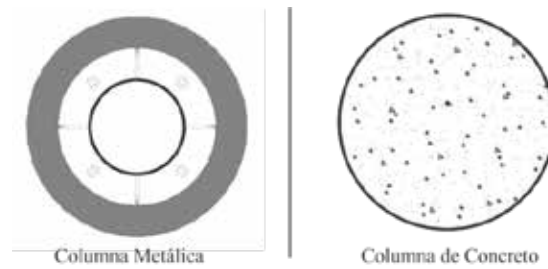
Secciones de columnas usados en el proyecto. (2016)
